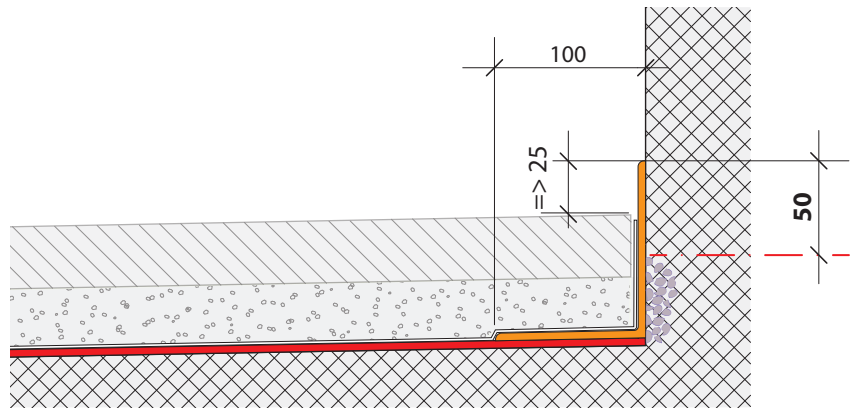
FLK-Anschluss auf zweilagiger bitumiger Abdichtung bei Schwellenanschluss, Anschlusshöhe über Nuttschicht unter 60 mm. Ausnahmeregelung Norm SIA 271, Ziffer 5.2 beachten!
